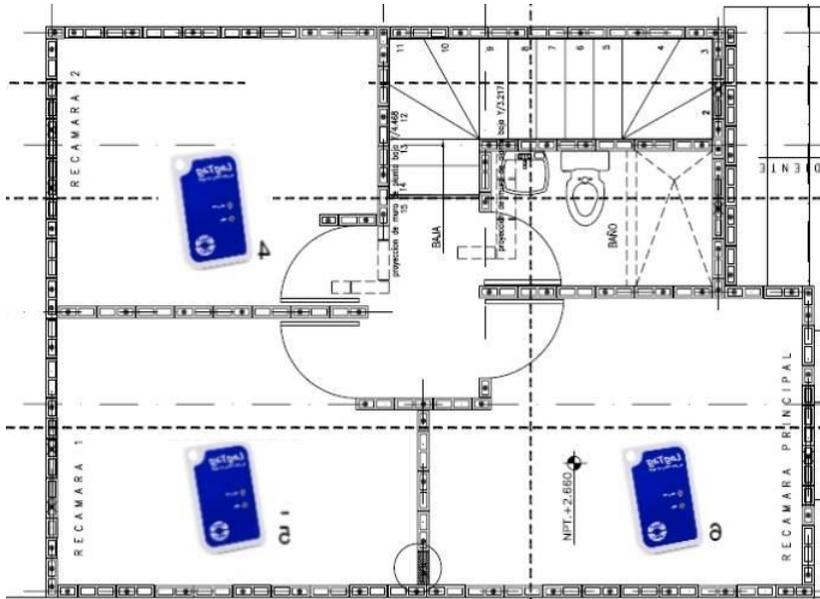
Planta arquitectónica de la vivienda uno, segundo nivel Orientada al Este
